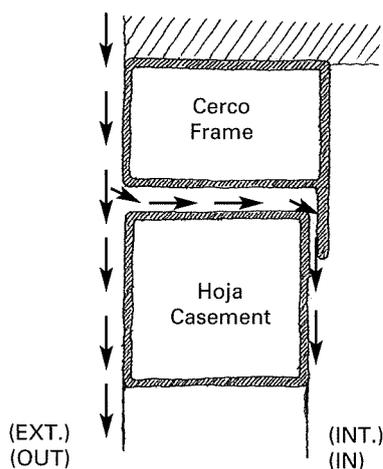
Sección vertical de encuentro de cerco y hoja de carpintería sencilla con apertura al exterior en disposición enrasada con la fachada.
